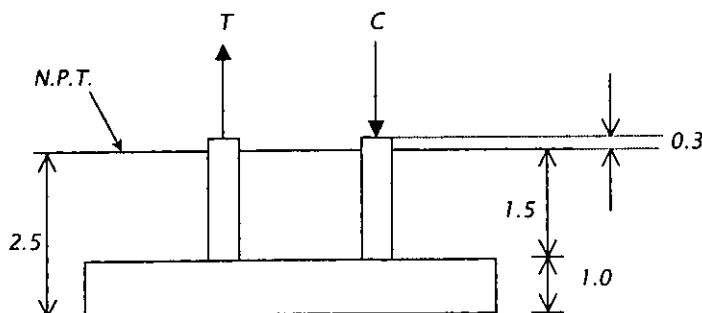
1. Esquema de Losa de Cimentación (Unidades en metros).
